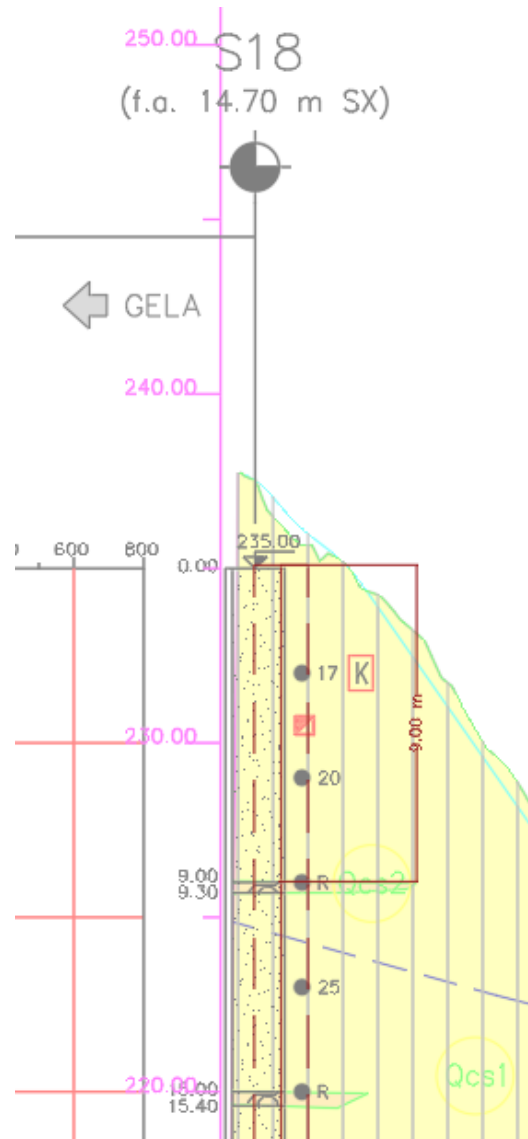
Localizzazione piano di posa della fondazione del muro sul profilo geotecnico
